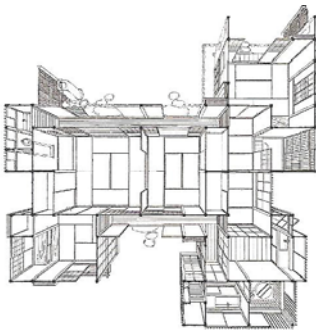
Grundriss eines Japanischen Wohnhaus
